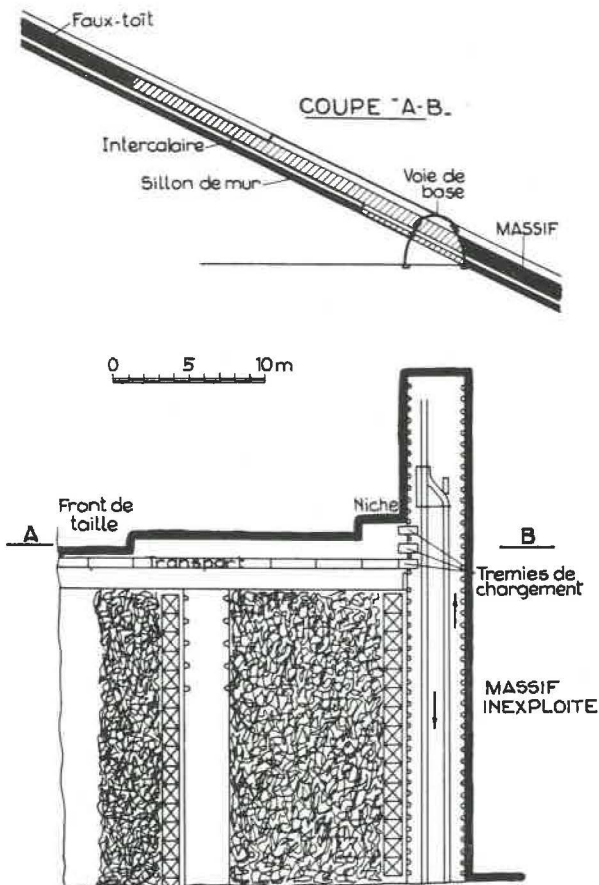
Voie de base et pied de taille dans Grosse Fosse à 903 m. Coupe verticale AB à travers la taille et vue en plan faisant apparaître les dimensions importantes de l'ouverture de taille au point de chargement.
